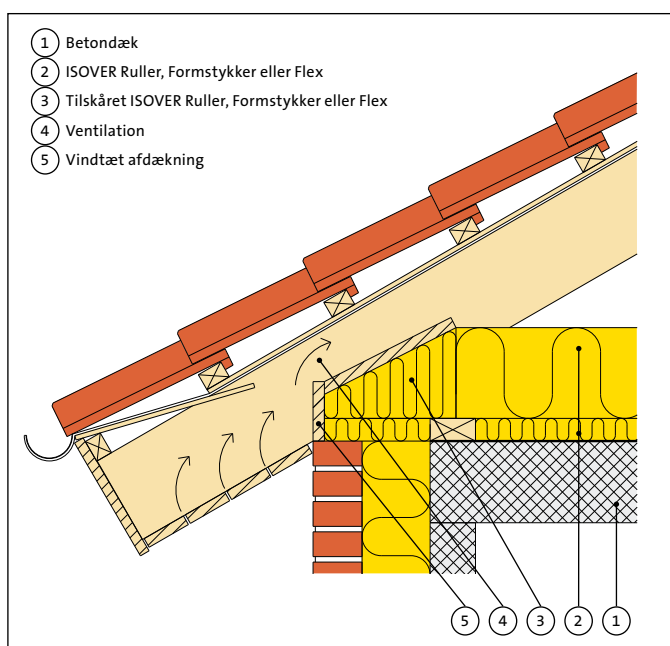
Loftkonstruktion i etagebolig med betondæk isoleret med flere lag ISOVER.
